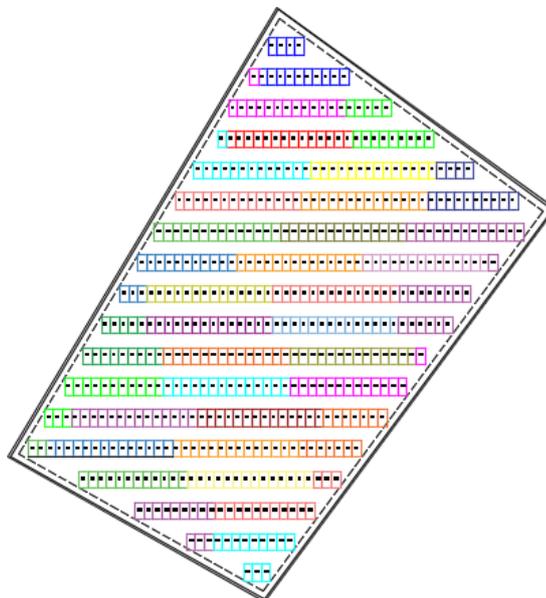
Distribución de los paneles fotovoltaicos en la cubierta.
